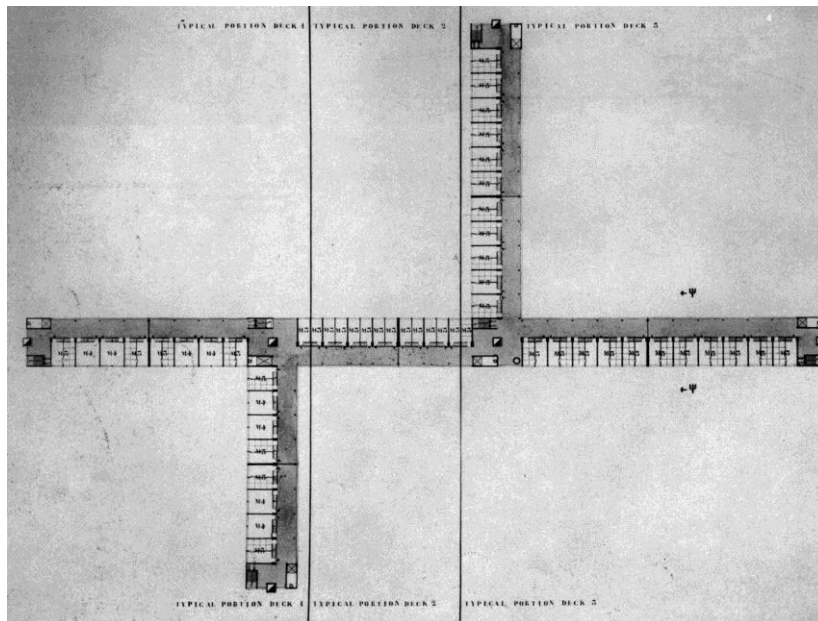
Horizontaler Schnitt durch ein Geschöß des Golden Lane Entwurfs
